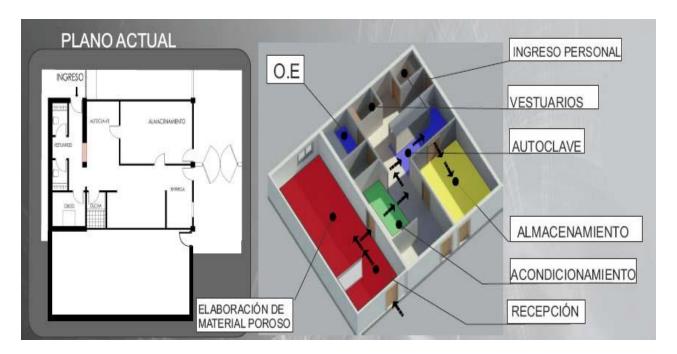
Plano actual de la planta física destinada a ala Central de Esterilización, y vista 3D.
